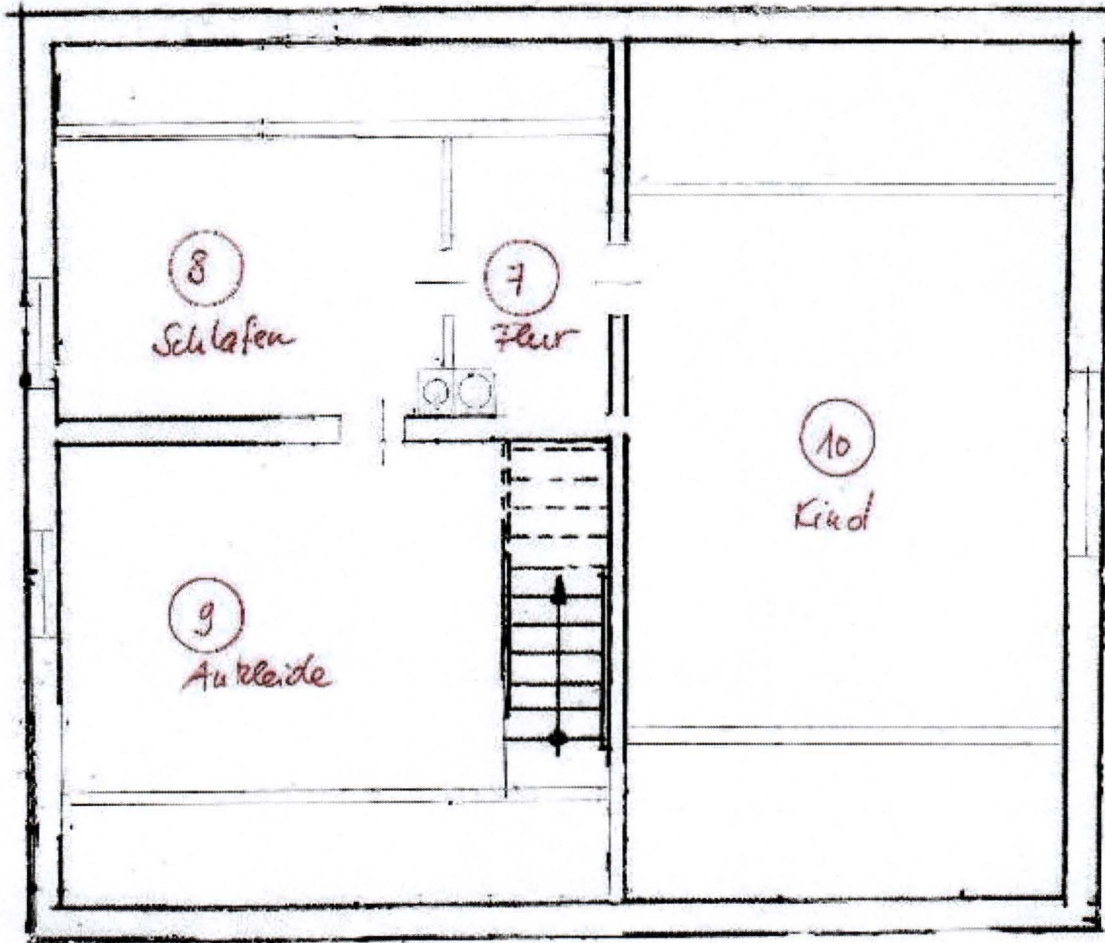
Wohnhaus, Grundriss DG
